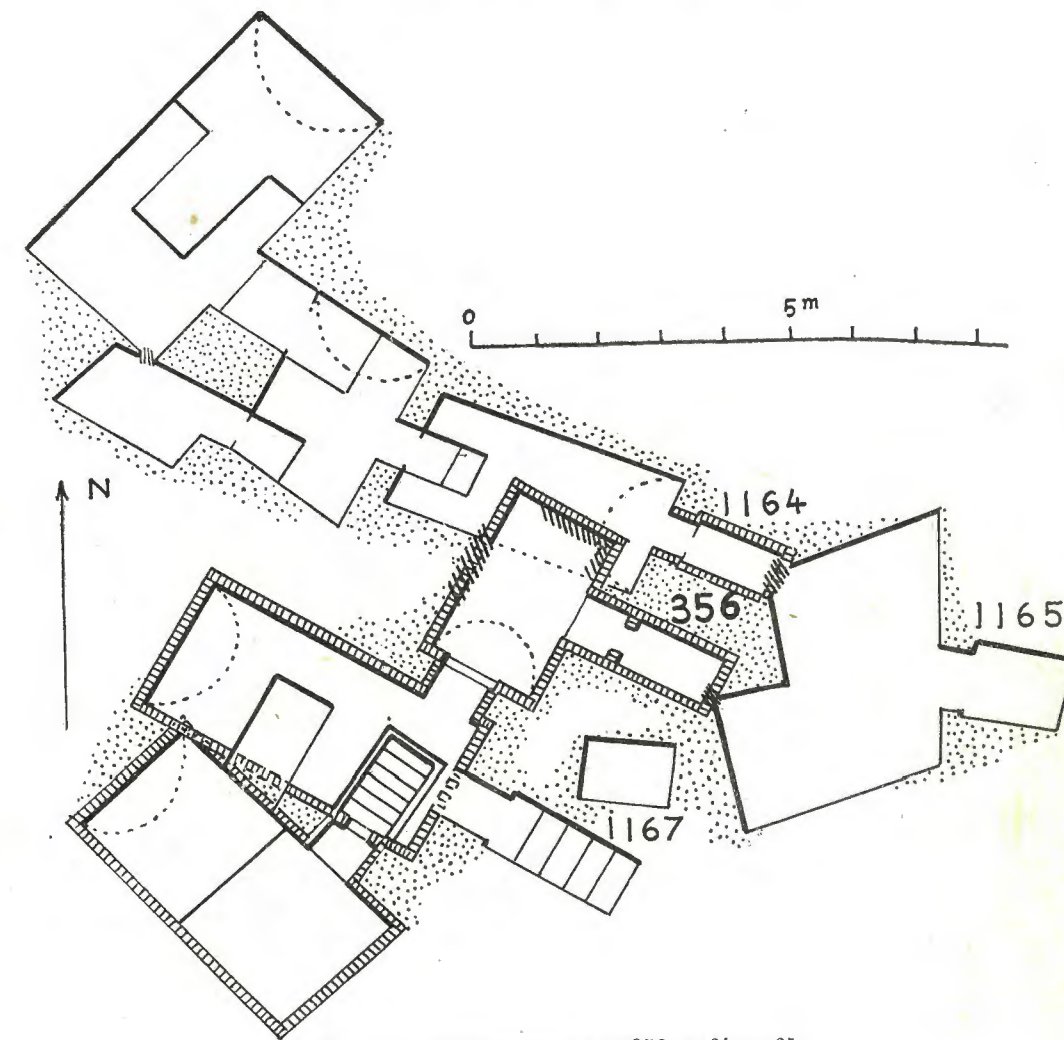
PLAN DES CAVEAUX N° 356, 1164, 1165.
